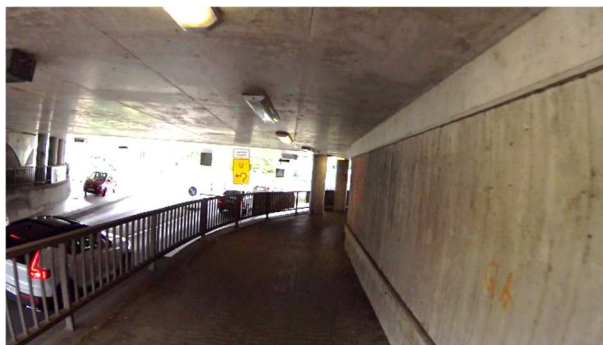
Bahnunterführung – Seitenraum westliche Straßenseite in Richtung Kreisverkehr Berliner Platz
